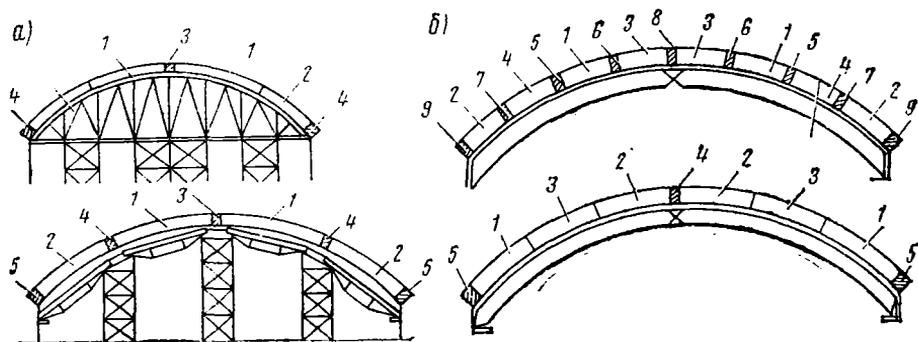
Схема деления на секции бетонирования арочных конструкций при кружалах:
